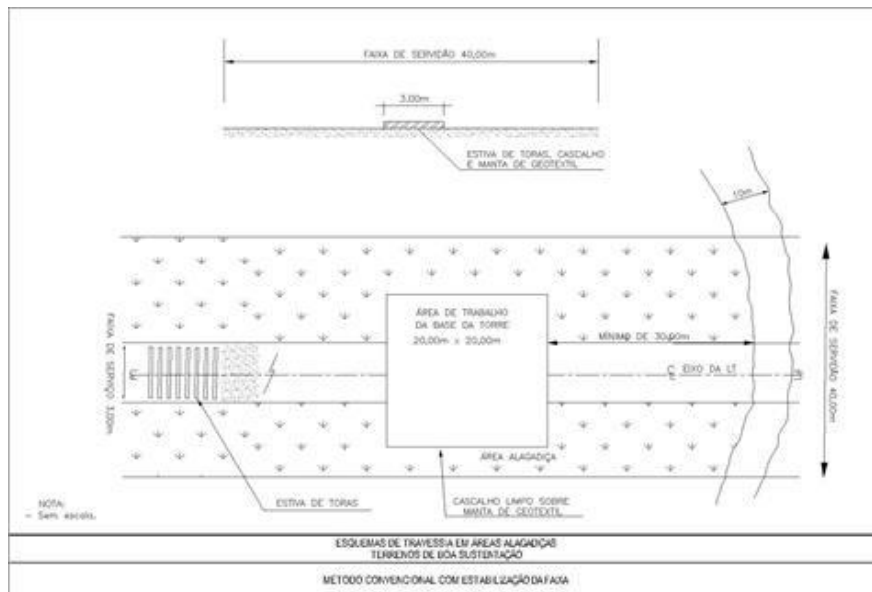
Construção em áreas de várzea, em terrenos de boa sustentação.
